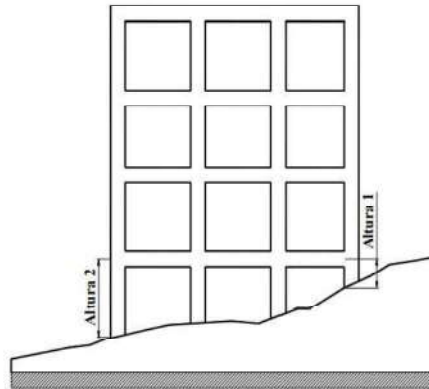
Variaciones de alturas típicas en de columnas
